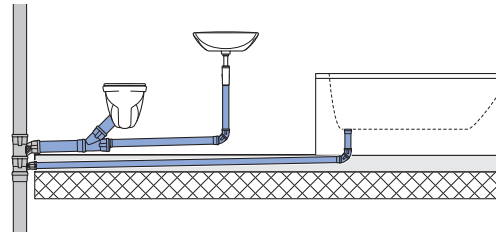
Ausführung mit Einzelanschlussleitung im Fußbodenaufbau und Sammelanschlussleitung über dem Fußbodenaufbau
